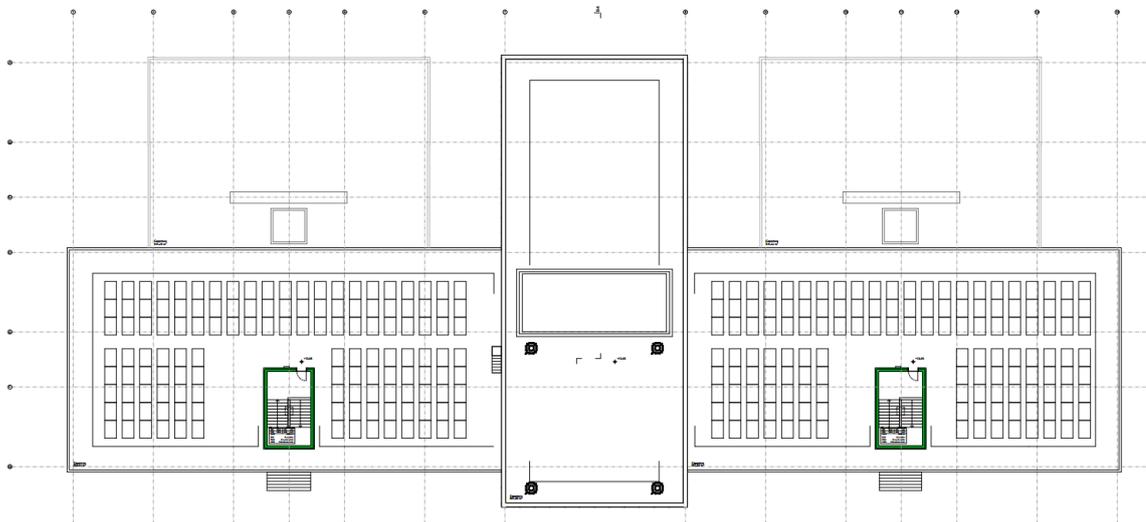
Pianta piano copertura – Durisch + Nolli Architetti sagl
